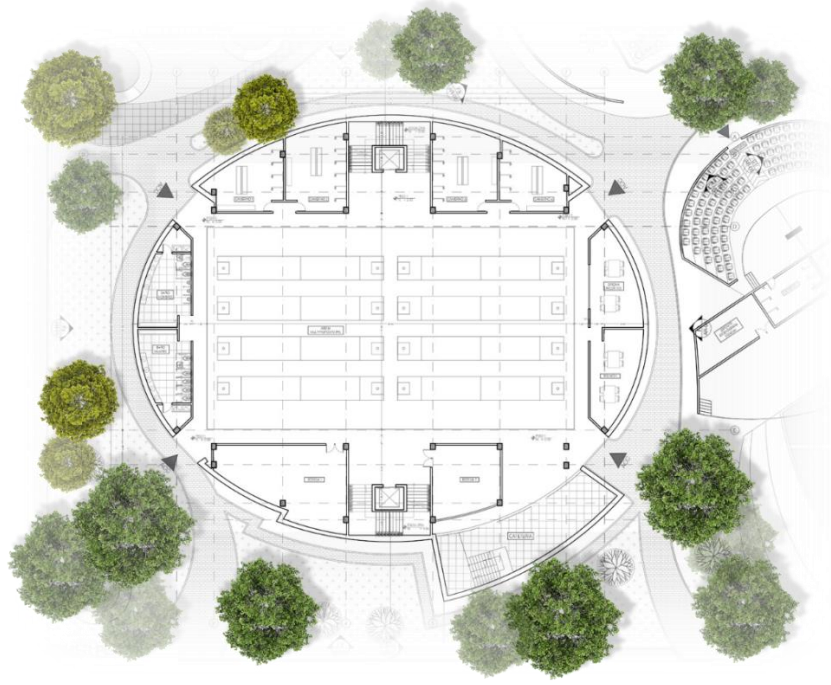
Planta Tipo primer piso arenas deportivas. Elaboración propia.
